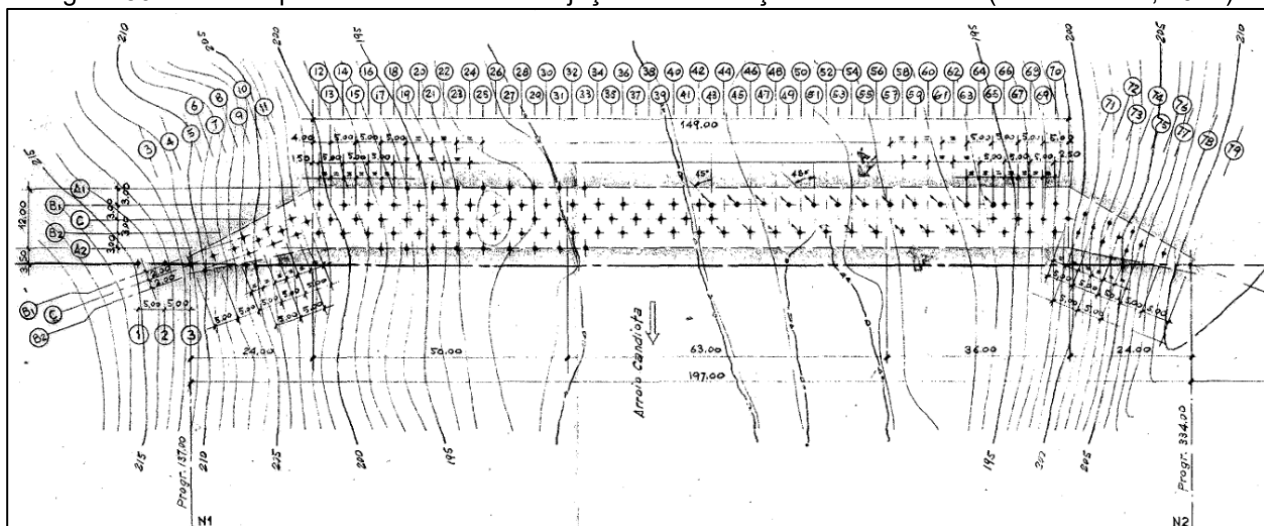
Vista em planta das cortinas de injeções na fundação do barramento (Eletroconsult, 1971)
